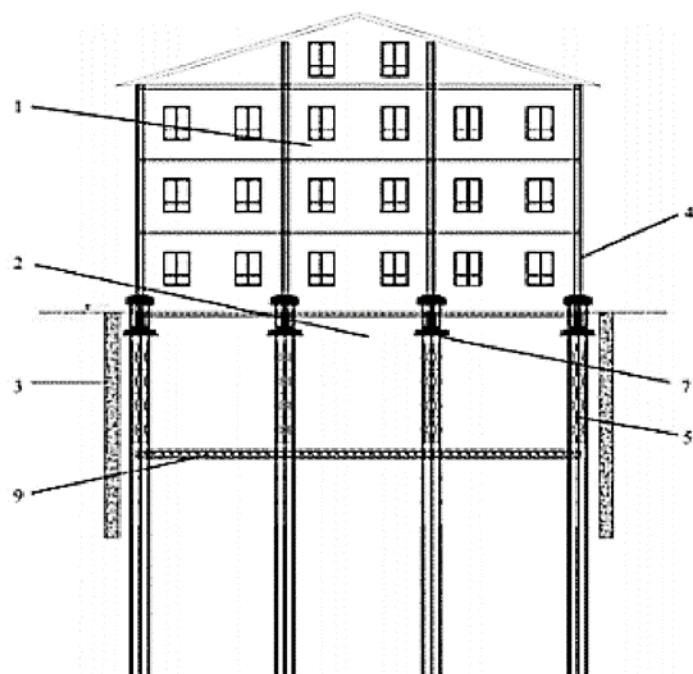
Схема влаштування підземного поверху: 1 - будівля; 2 - підземна споруда; 3 - контур огорожі підземної частини; 4 - існуючі стіни та/або колони будівельних конструкцій; 5 - в'язі по палях; 7 - оригінальний фундамент; 9 - нижня плита підземної споруди
